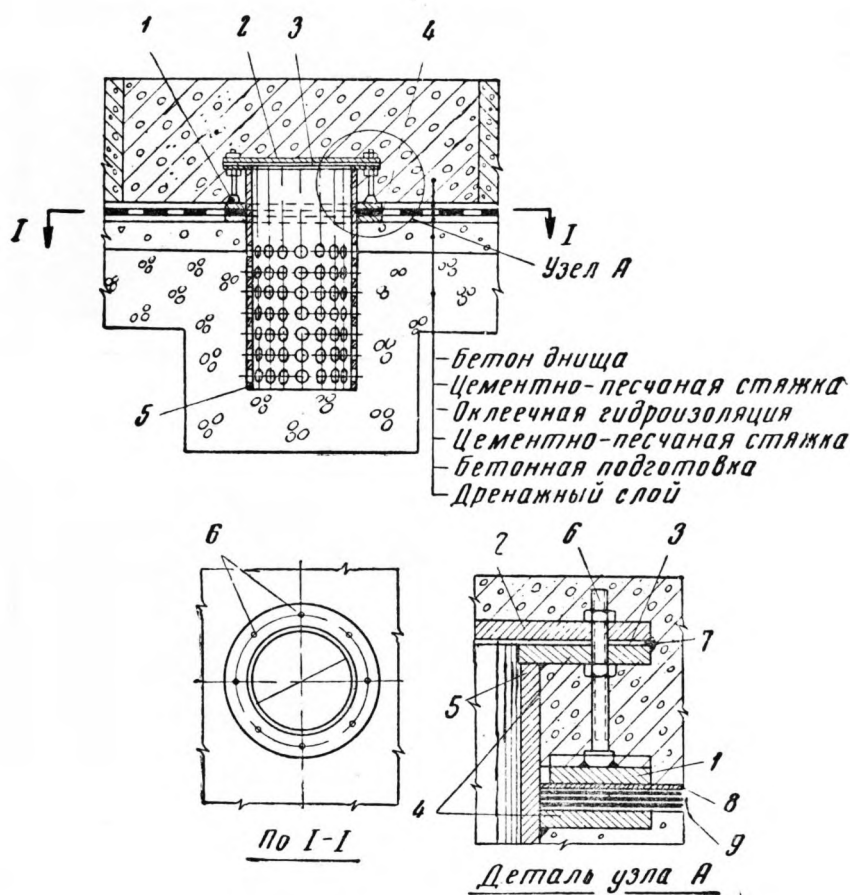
Конструкция гидроизоляции у предохранительного колодца
